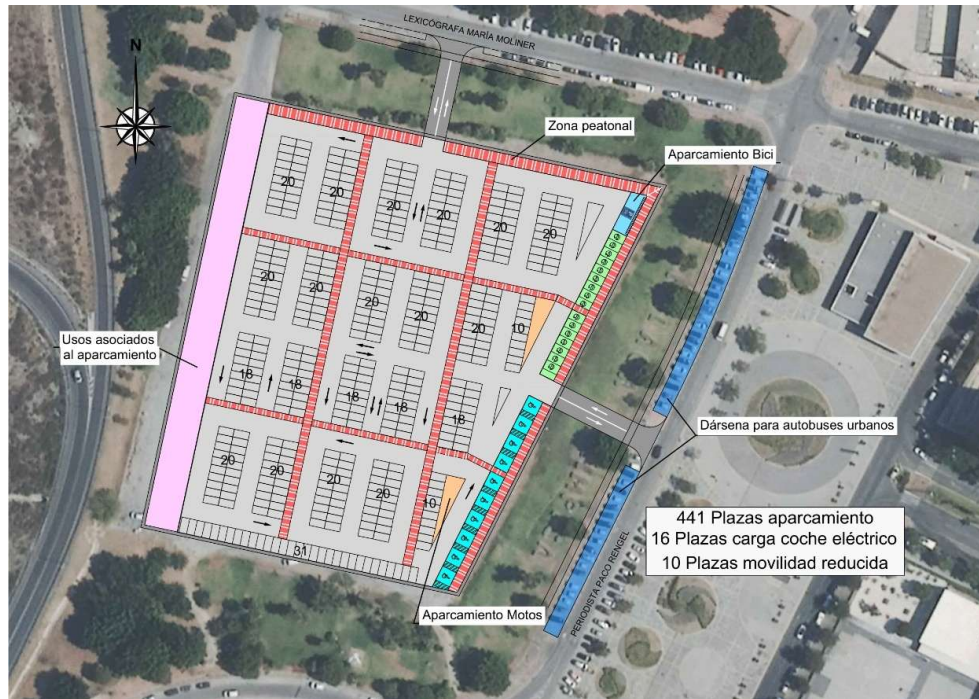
Ordenación en planta del futuro aparcamiento disuasorio.
